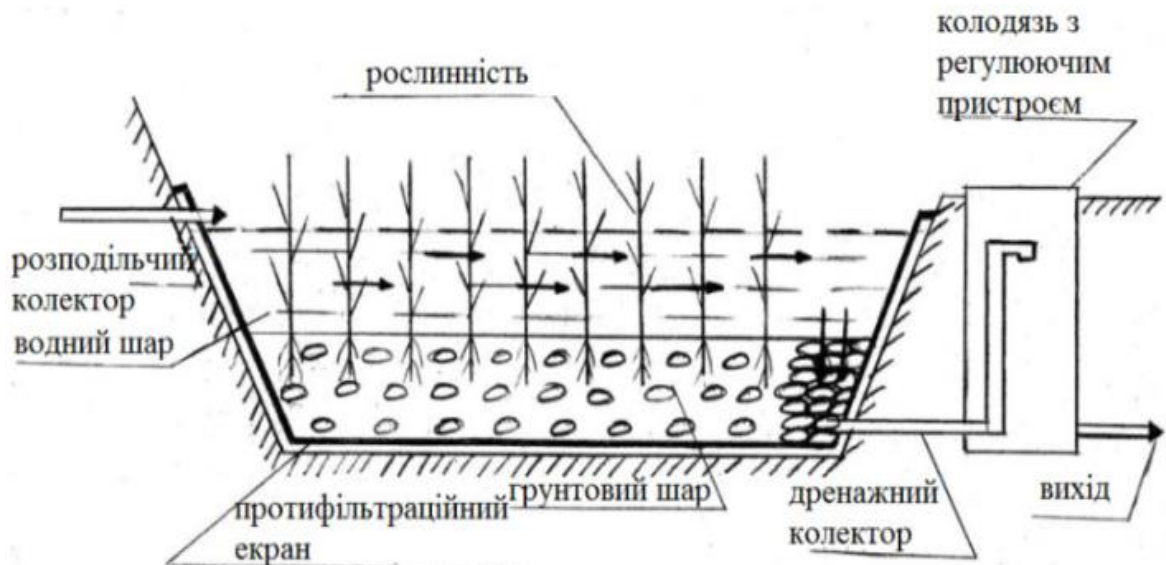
Схема поверхневого біоплато [12, с. 60]
